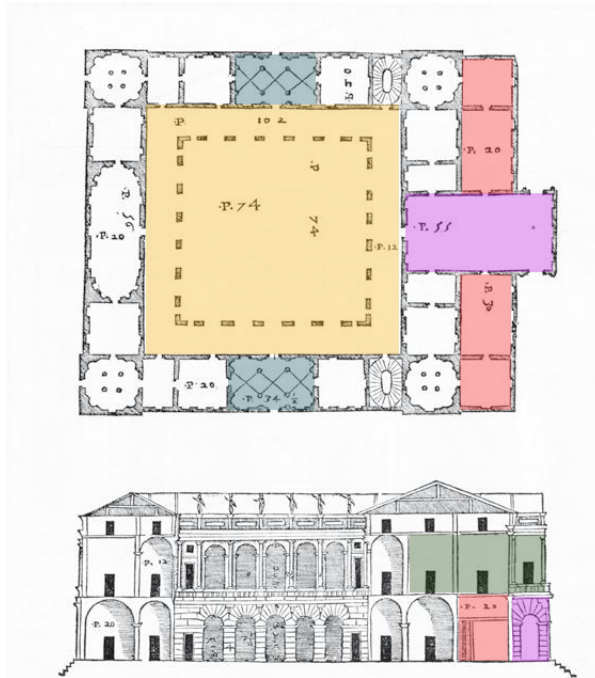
Planta arquitectónica y corte de la casa del conde Ottavio Thiene en Vicenza, Italia.
